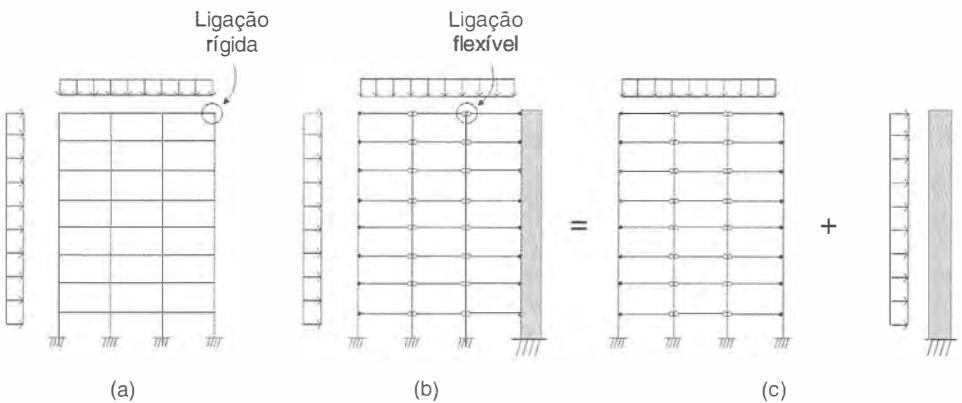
Tipos de estruturas de edifícios: (a) pórtico (com ligações rígidas entre vigas e pilares); (b) estrutura com ligações viga-pilar flexíveis, a qual deve estar associada a uma subestrutura de contraventamento para fornecer rigidez lateral e resistir às ações horizontais; (c) decomposição dos sistemas componentes da estrutura da figura b com subestrutura de contraventamento do tipo parede-diafragma.
